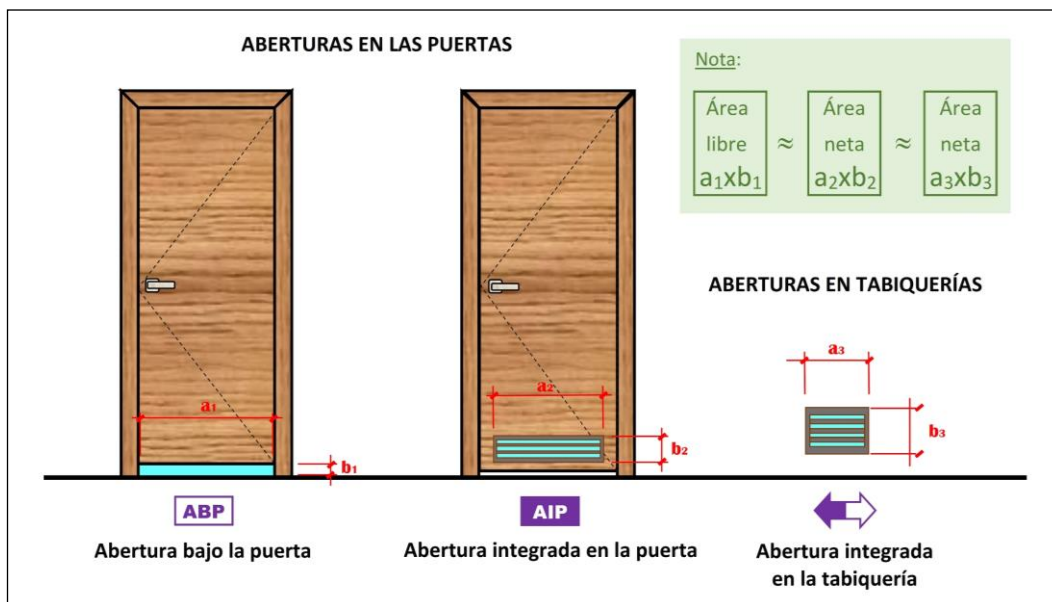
Propuesta del autor para la representación gráfica en los planos, de las aberturas de paso para la ventilación. Arriba vista en alzado, y abajo diseño de los logos de indicación en la planta de la vivienda.
